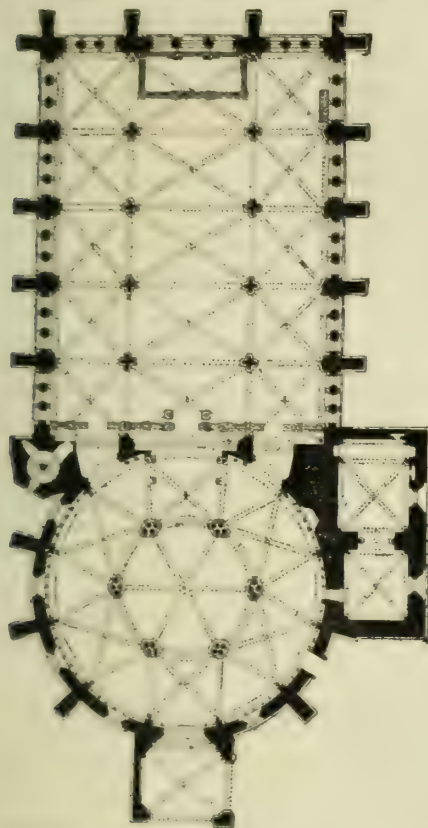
Plan de l'église du Temple, à Londres (d'après Britton).
